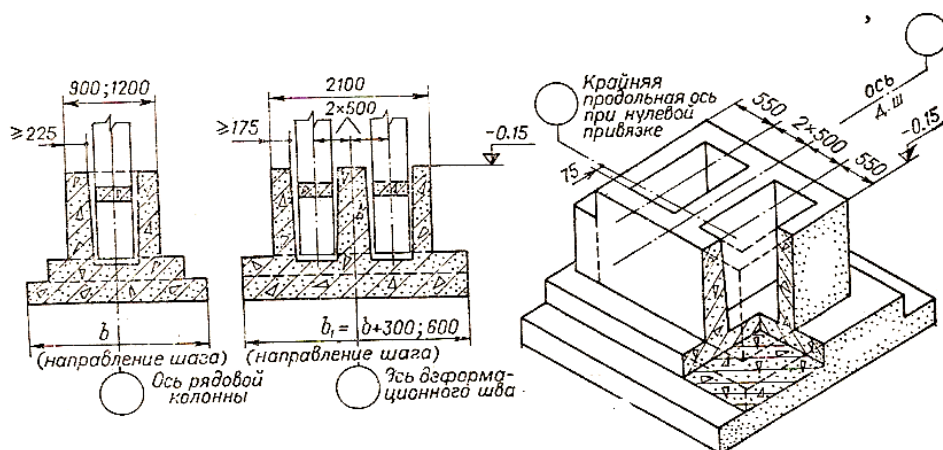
Монолитные фундаменты железобетонных колонн в местах устройства деформационных швов
